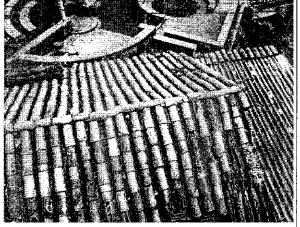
Aspecto general de la cubierta zona frontal (costado sur) de la edificación emplazada en el predio de la Calle 8 No. 0-20. Se observa un buen estado de conservación de la cubierta (zona frontal).
